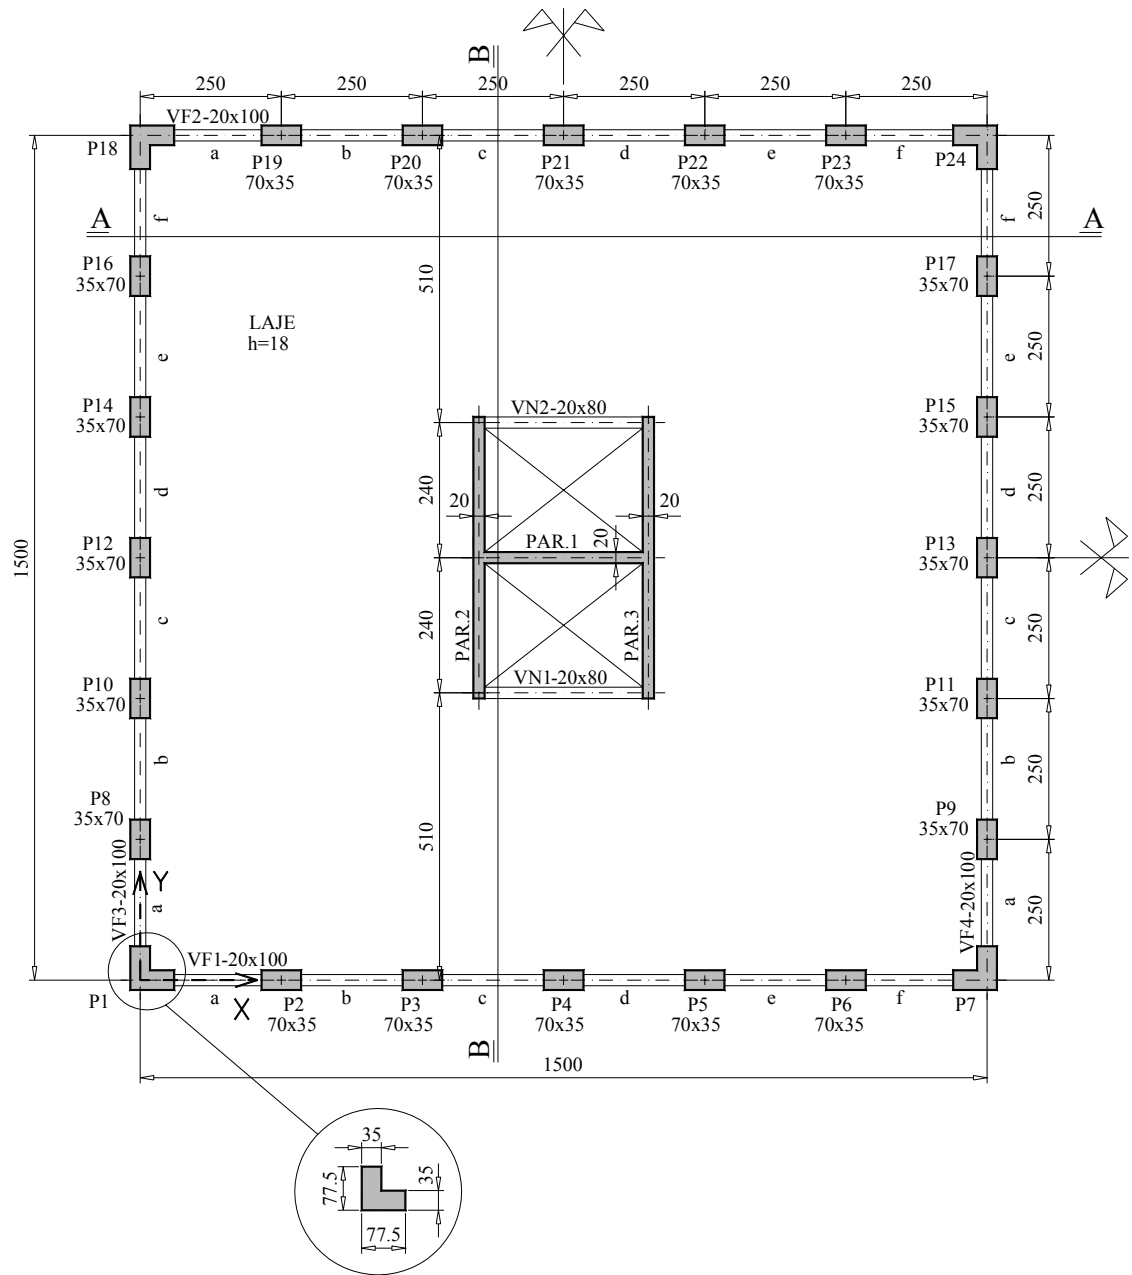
Planta do 11° ao 15° andar (cotas em centímetros)
